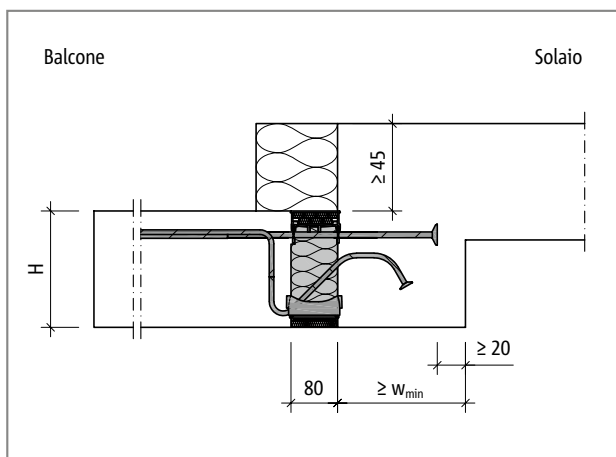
Schöck Isokorb® T tipo KL-U: balcone con dislivello verso il basso e isolamento esterno
